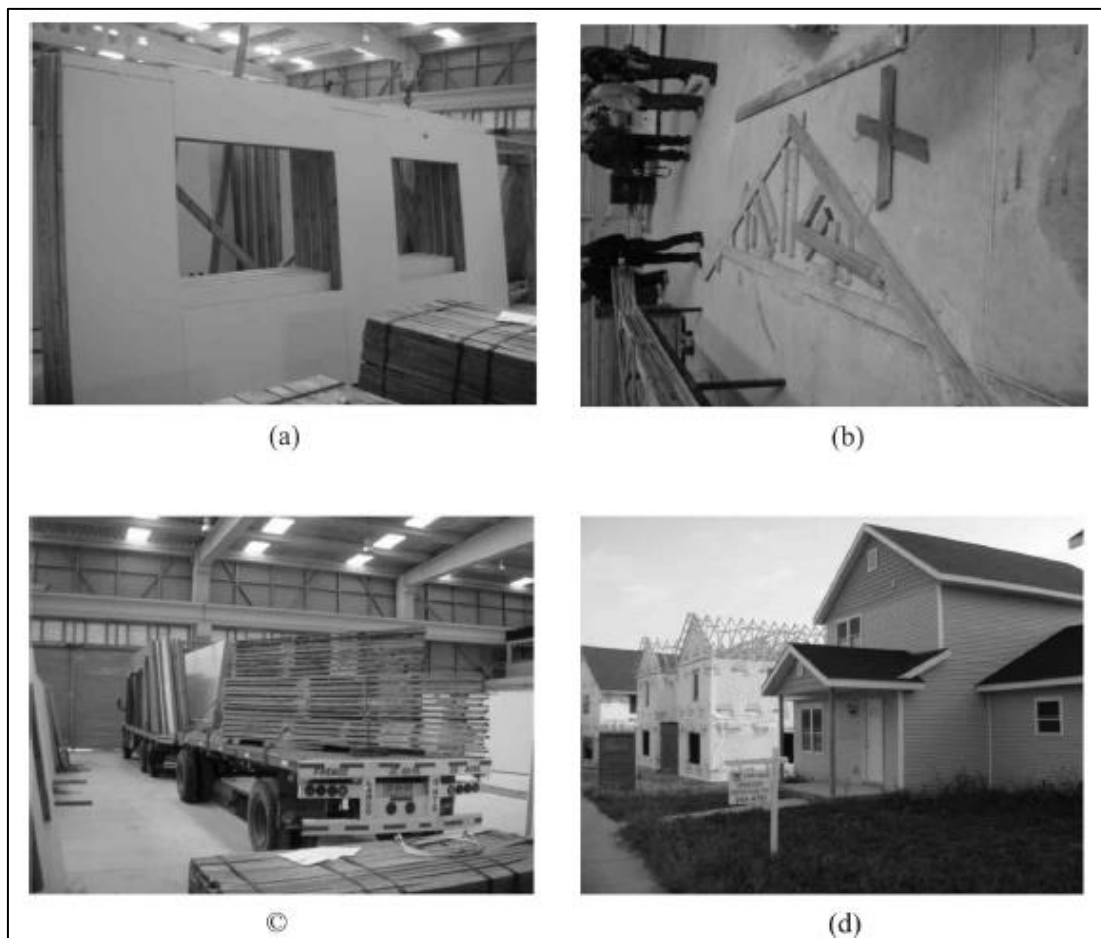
Fabricação industrial: (a) Painéis de parede (b) Treliças de cobertura; (c) Transporte indústria/obra; (d) Casa pronta
